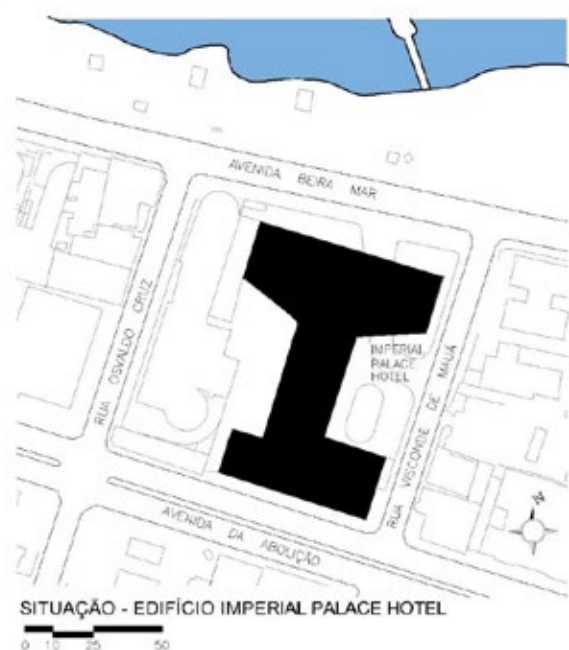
Planta de Situação Imperial Palace Hotel (1964), Armando Farias e Neudson Braga
